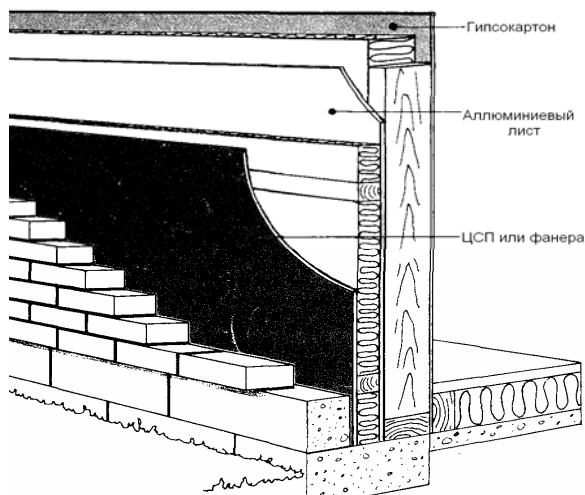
Конструкция стены каркасно-панельного дома, облицованного кирпичом
